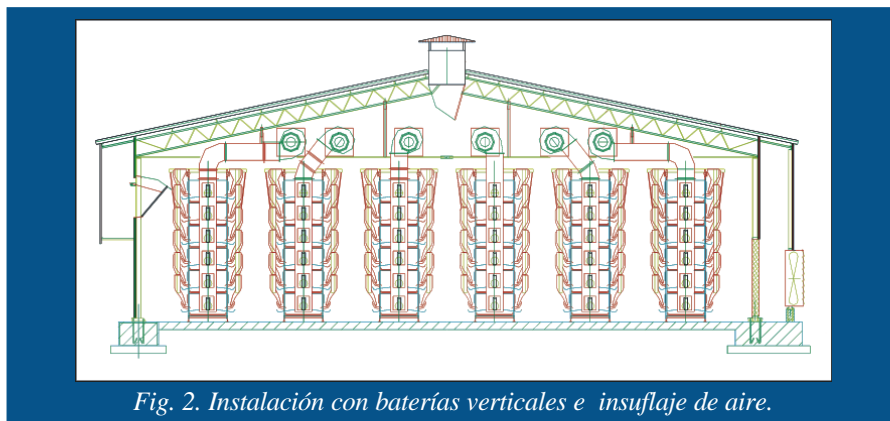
Instalación con baterías verticales e insuflaje de aire.
